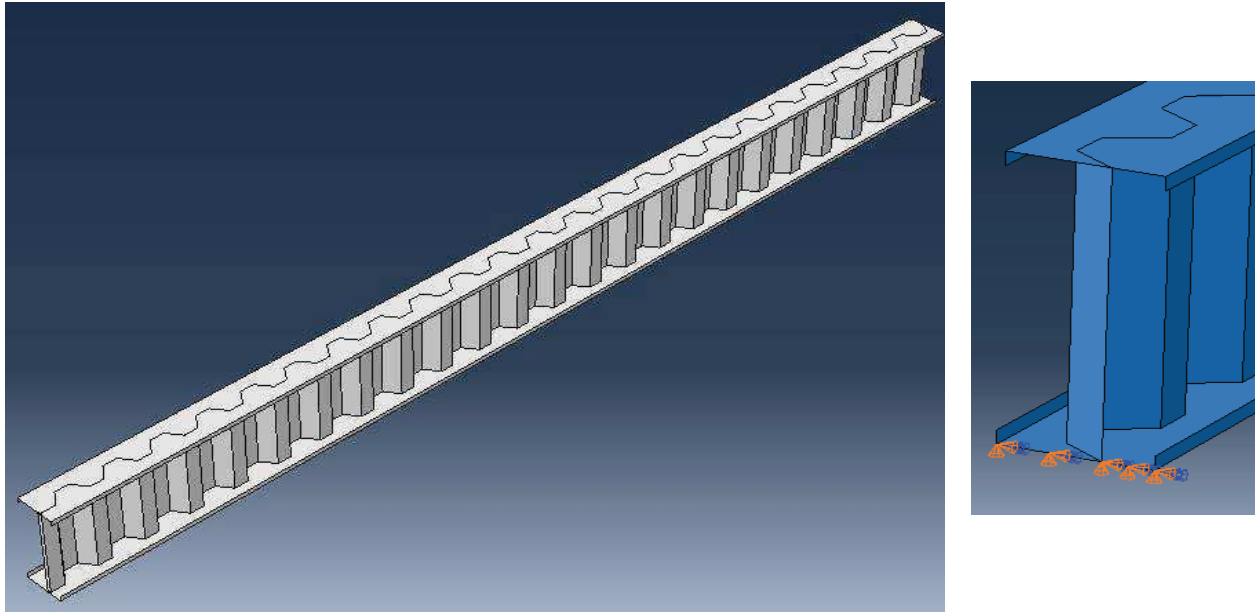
Présentation d'une poutre en I avec âme ondulée trapézoïdale.
